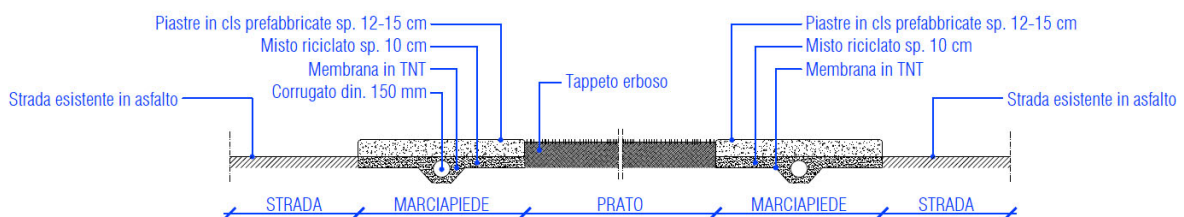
Sezione A-A (camminamento in elementi prefabbricati in cls)
